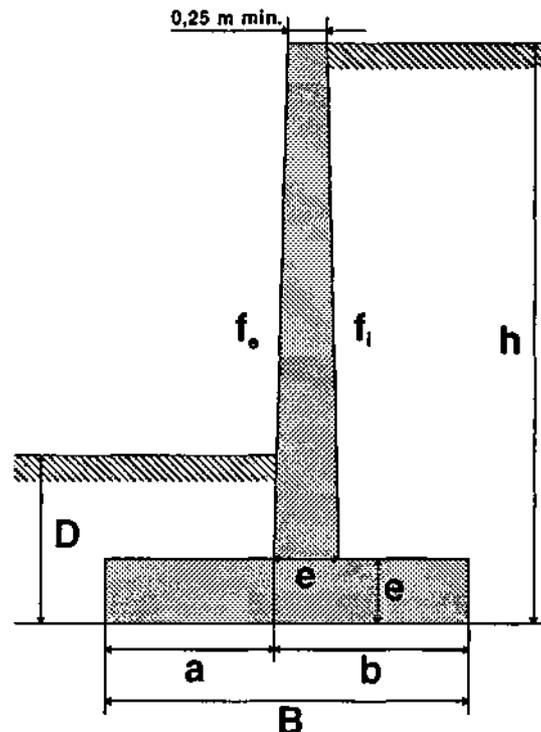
coupe transversale d'un mur en aile ou en retour
